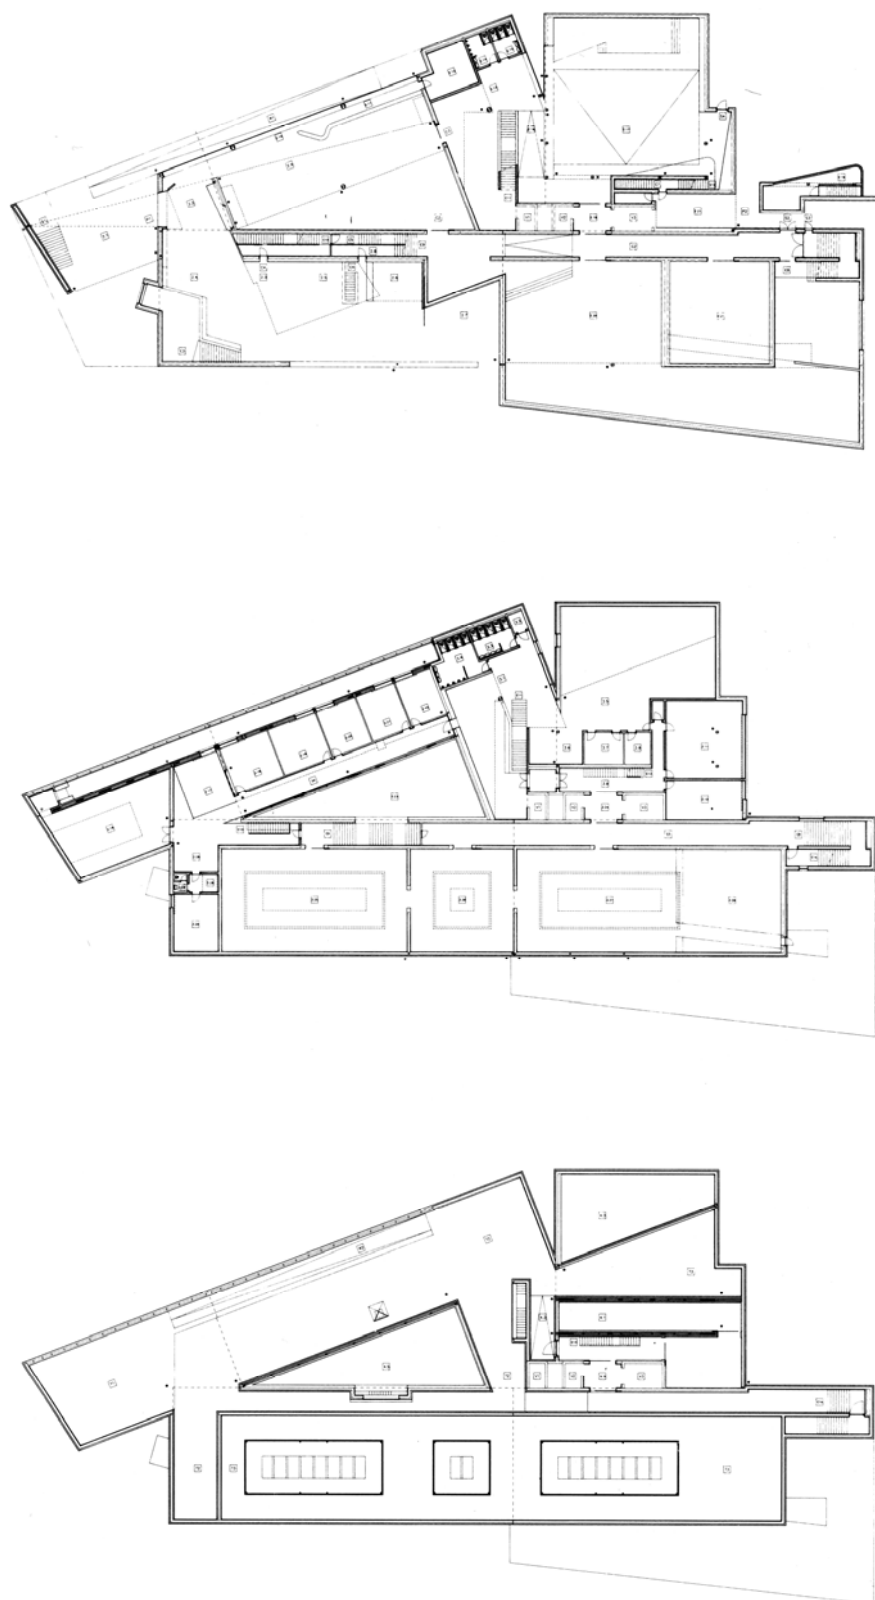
Centro de Arte Contemporânea da Galícia. Plantas de subsolo, térreo, primeiro/segundo pavimentos.
